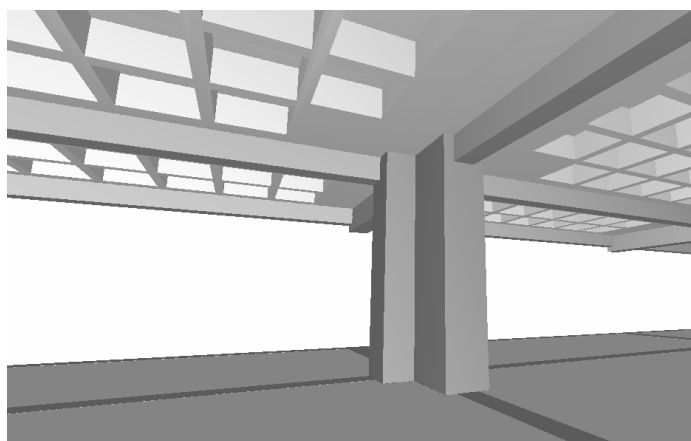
Região próxima ao Pilar P6 no modelo estrutural da Solução com Laje Nervurada
